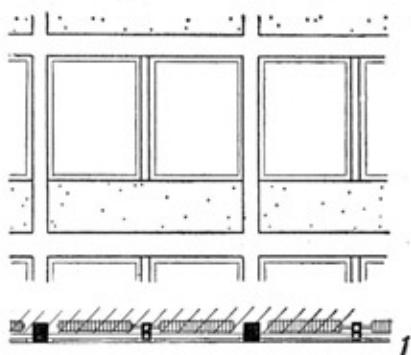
Вертикальные стояки трубопровода, проложенные в наружных колоннах
